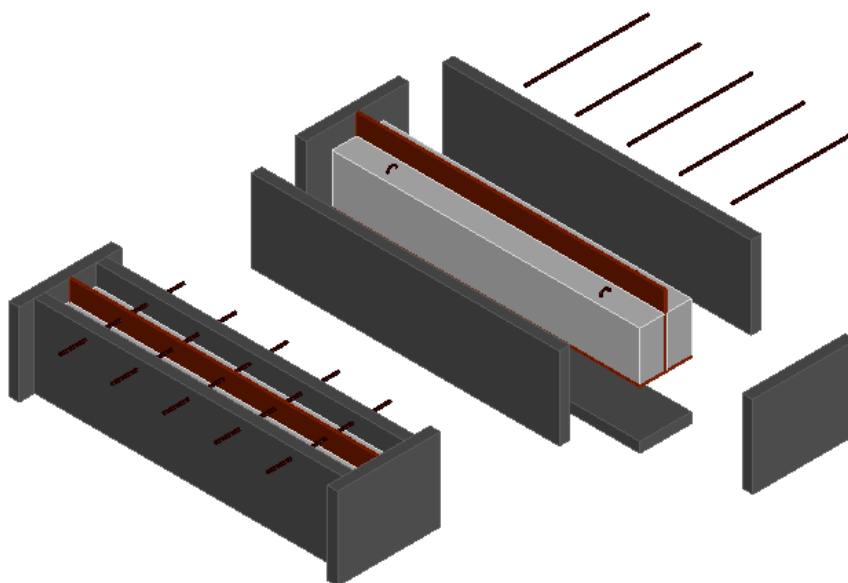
Esquema da cofragem das vigas em CAD (Silva, 2015)
